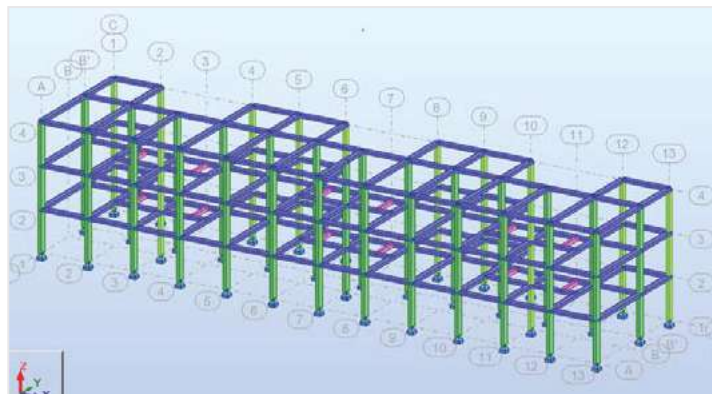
Modelación de Bloque de Viviendas tipo C41-P9
